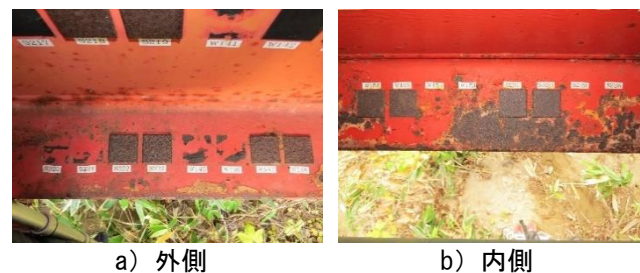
松ヶ崎橋 中間部 下フランジ面の状況
